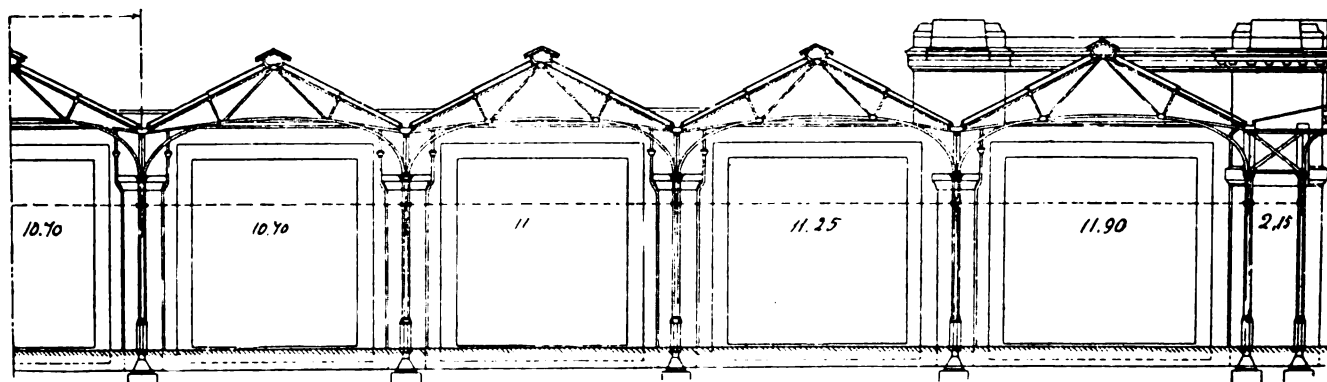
Stazione di Charing Cross. - Restante parte della sezione longitudinale verso il piazzale esterno.
